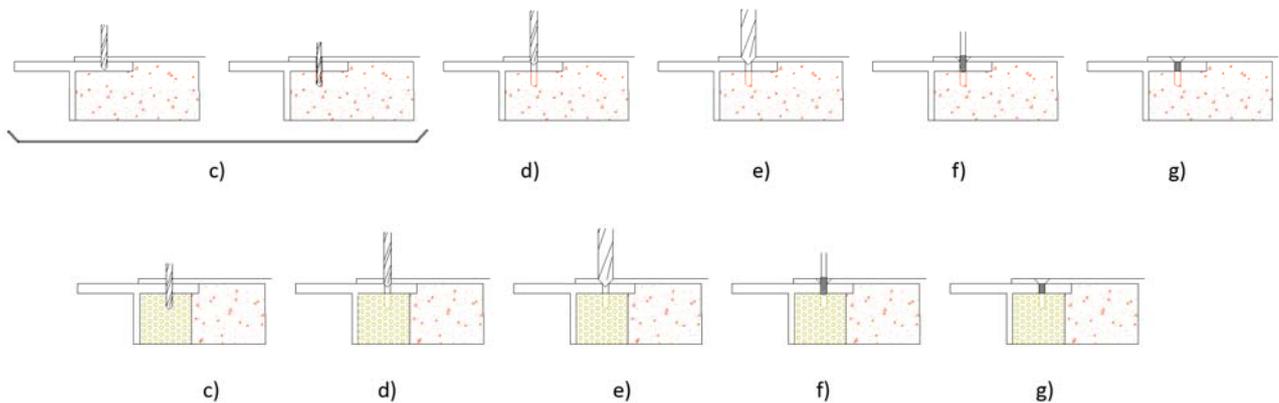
Atornillado de las chapas. Arriba con hormigón bajo la viga. Abajo con poliespan..
